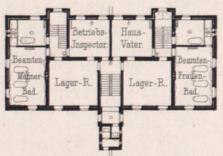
Oekonomie-Gebäude. Grundrifs des Erdgeschofses.
